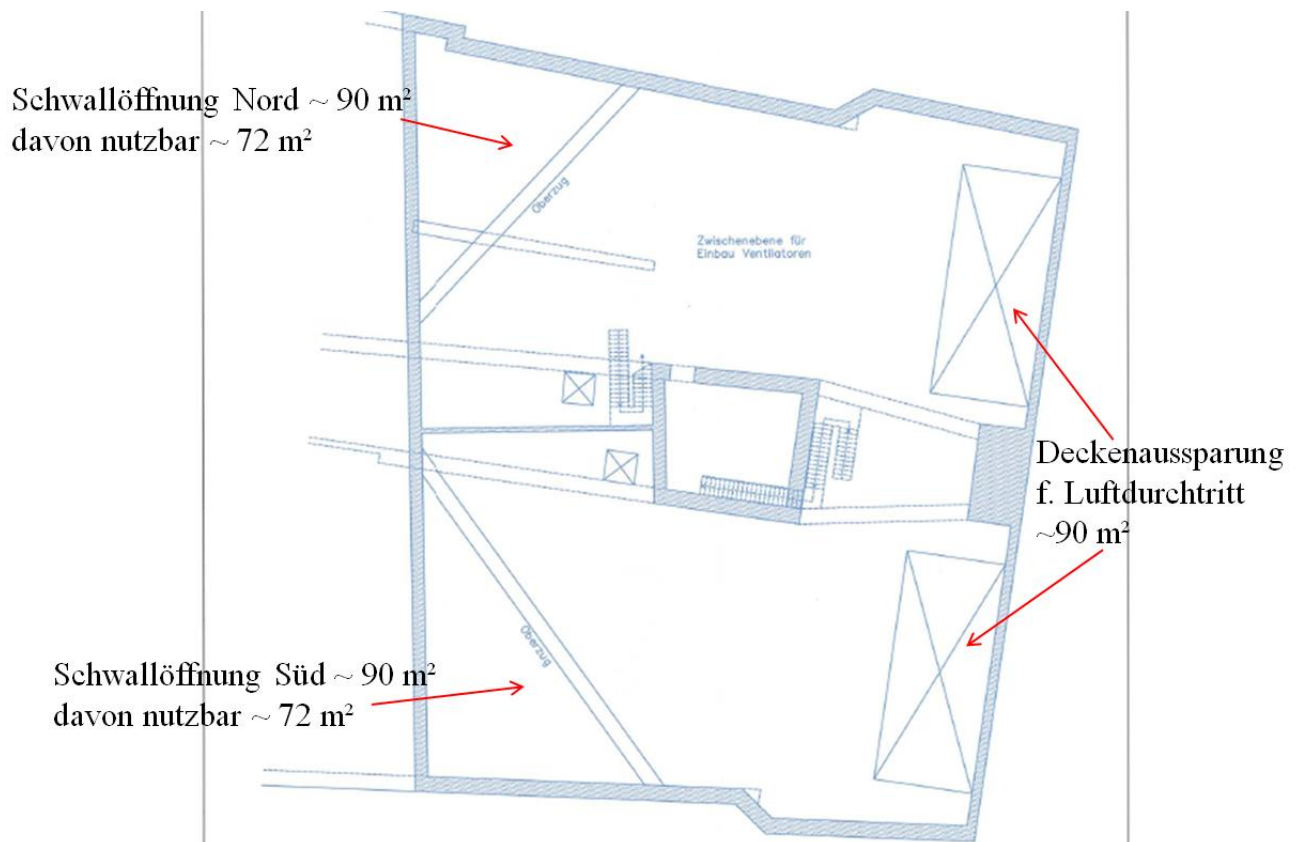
Schwallbauwerk Süd, Grundriß Zwischenebene für Gebläse-Aufstellung, Ausschnitt aus DB-Plan Anlage 7.1.4.8 „Schwallbauwerk Süd“ als leerer Plan!
